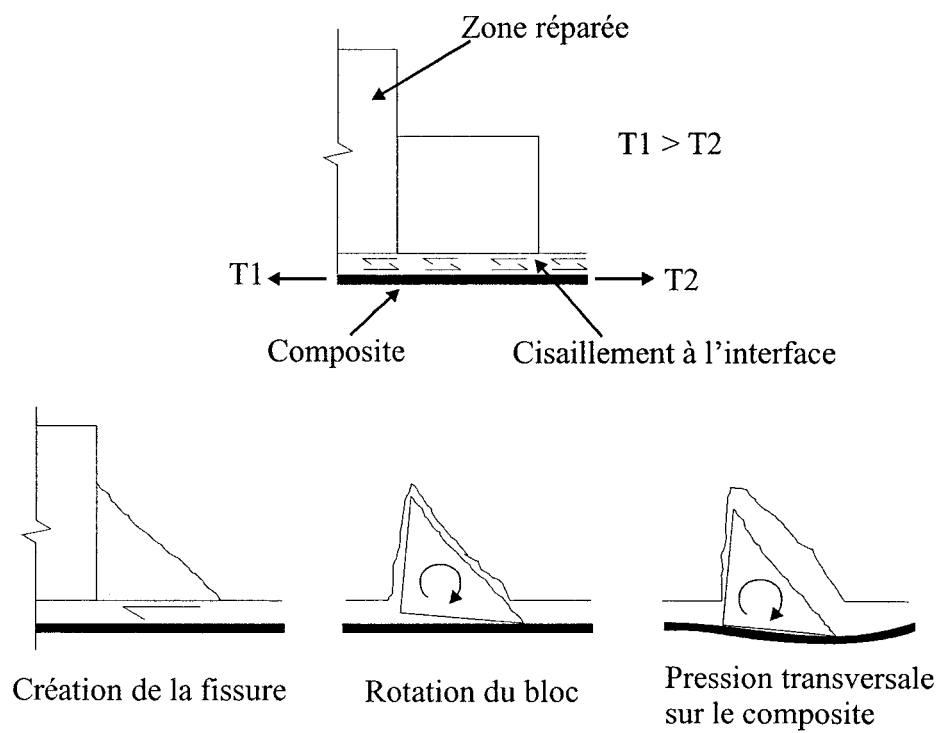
Fissuration et mécanisme de rupture – essai préliminaire
